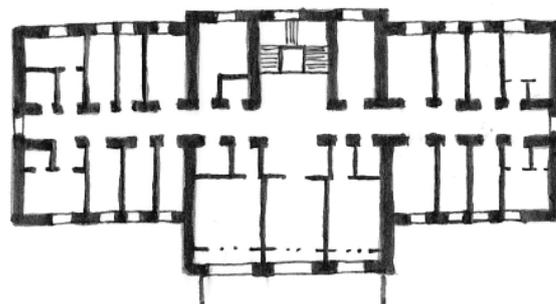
Hotel Bahnhof - Grundriss 1. Stock, 1928
